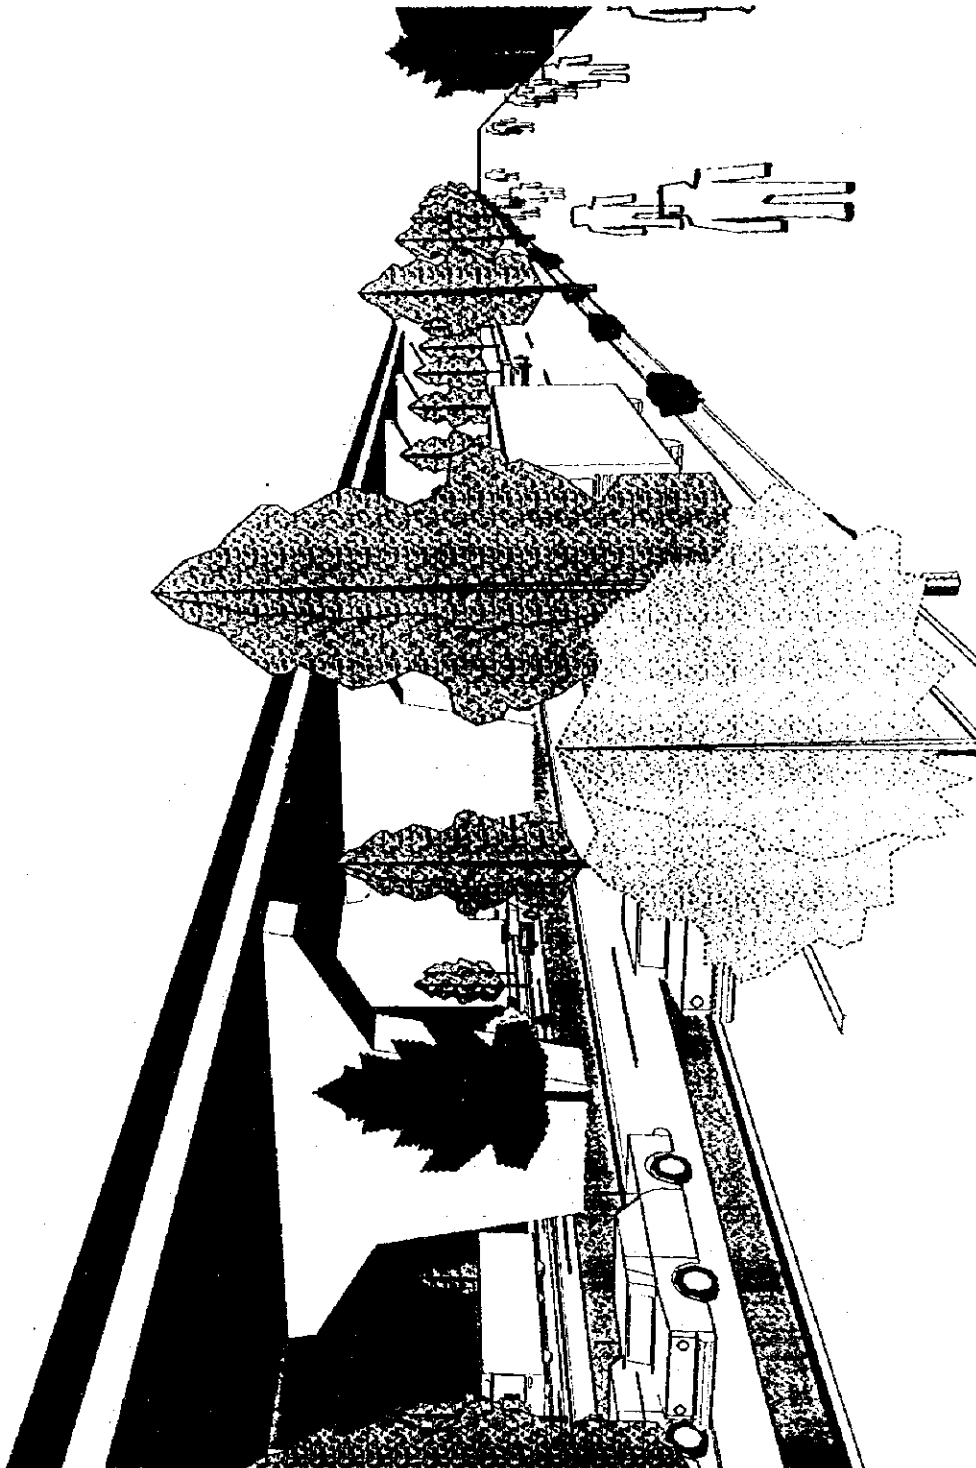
Plano tridimensional de la Alternativa A en la Calle 100 (1).
